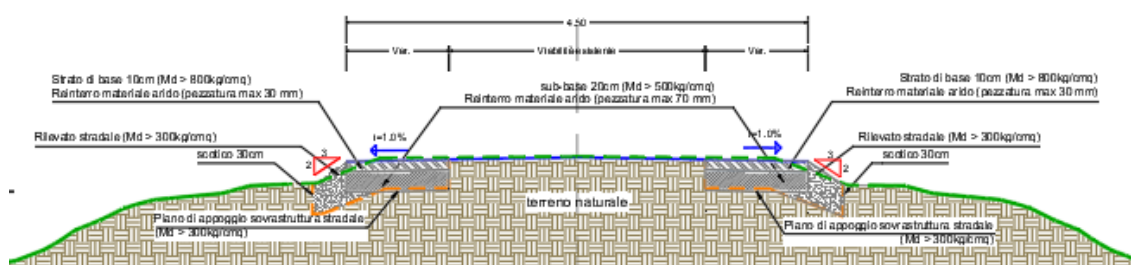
Sezione stradale tipo della viabilità esistente con adeguamenti stradali
